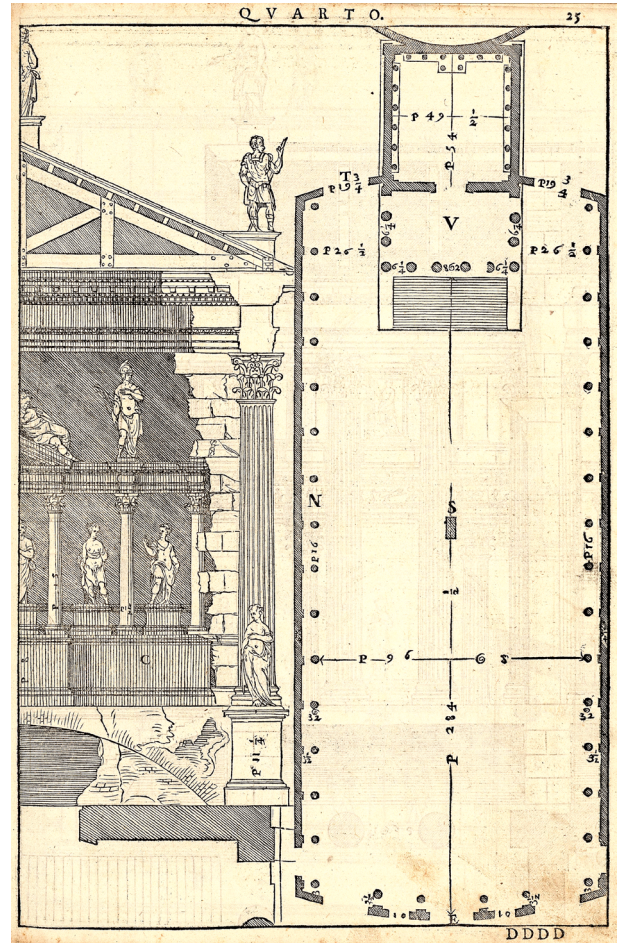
Alzado del pórtico del templo y planta del Foro de Nerva. Palladio 1570, IV, p. 26.
